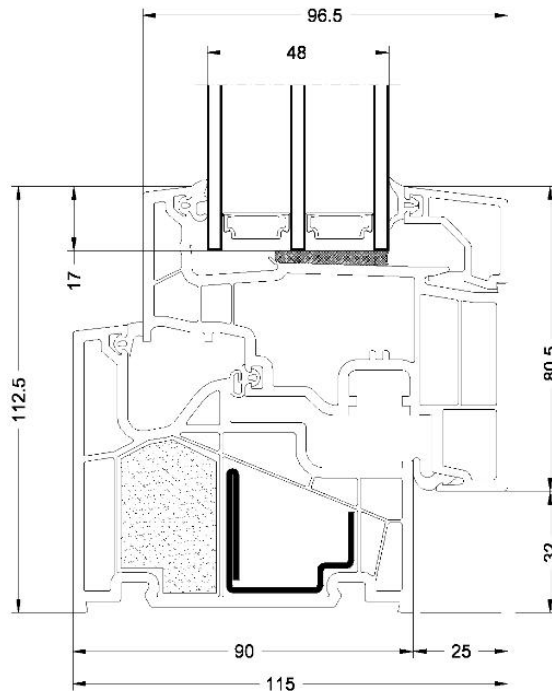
Querschnittdarstellung Rahmenprofil - Abstandhalter 03 „Technocform TGI-Spacer“
